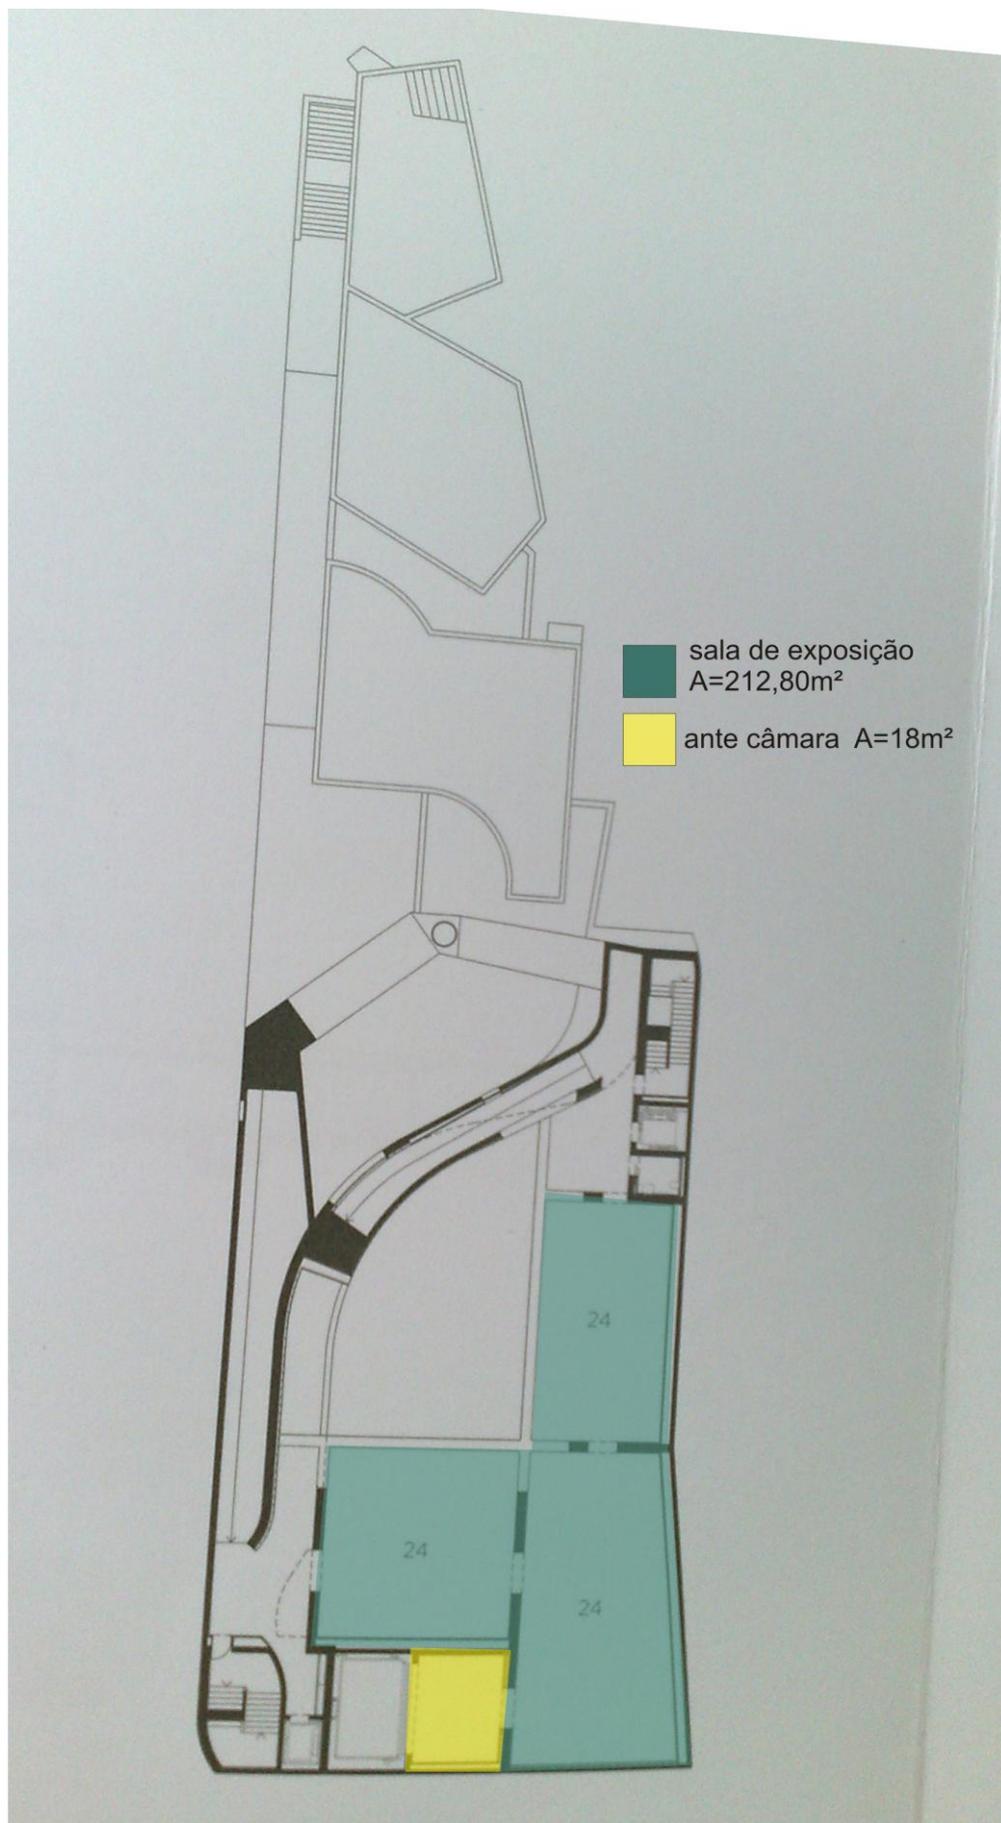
Planta Baixa 2º Pavimento (KIEFER, 2008)
